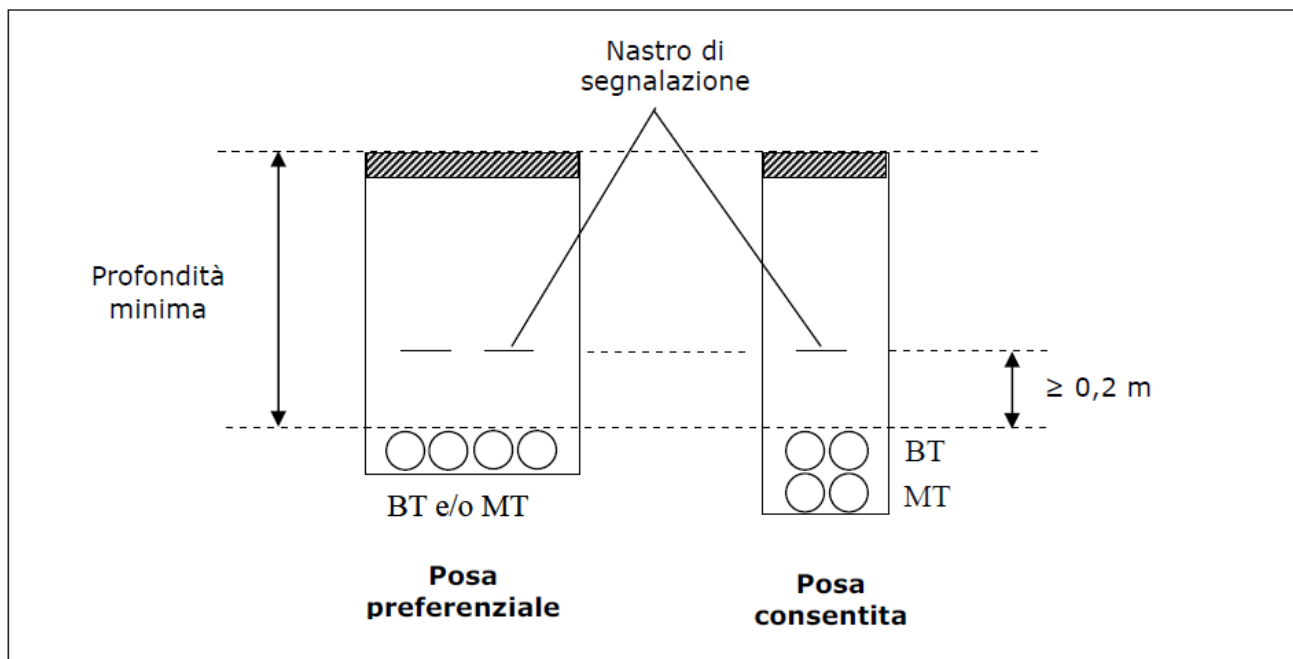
Disposizione conduttori MT e BT secondo specifica E-Distribuzione
